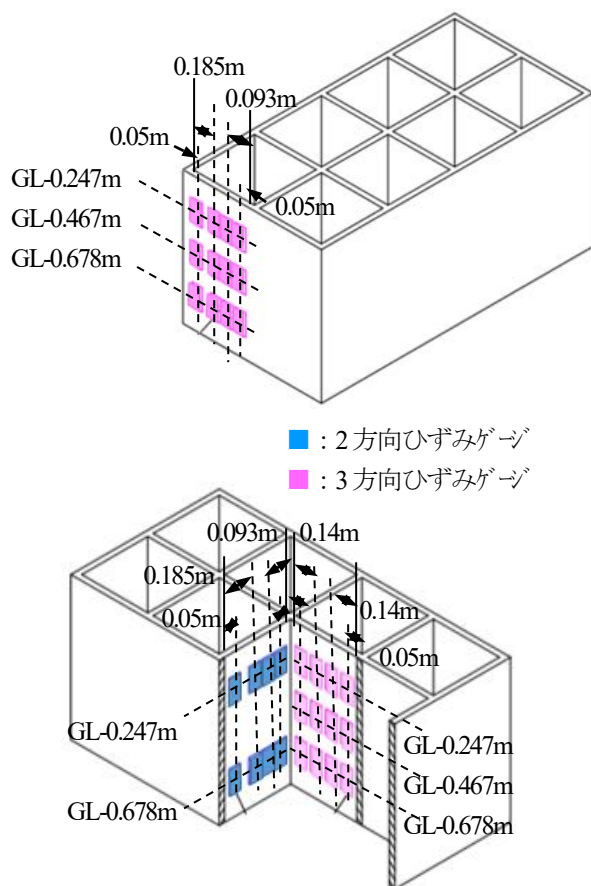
ひずみゲージ貼付け位置図(格子間隔0.4m)
